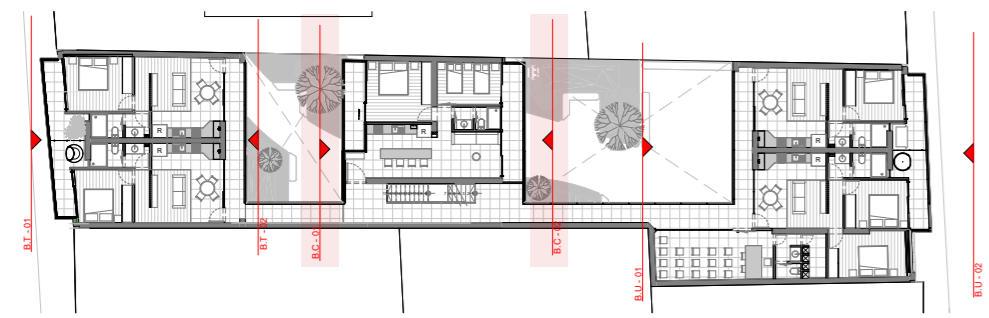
Planta de referencia para alzados. Fuente: Elaboración propia.
